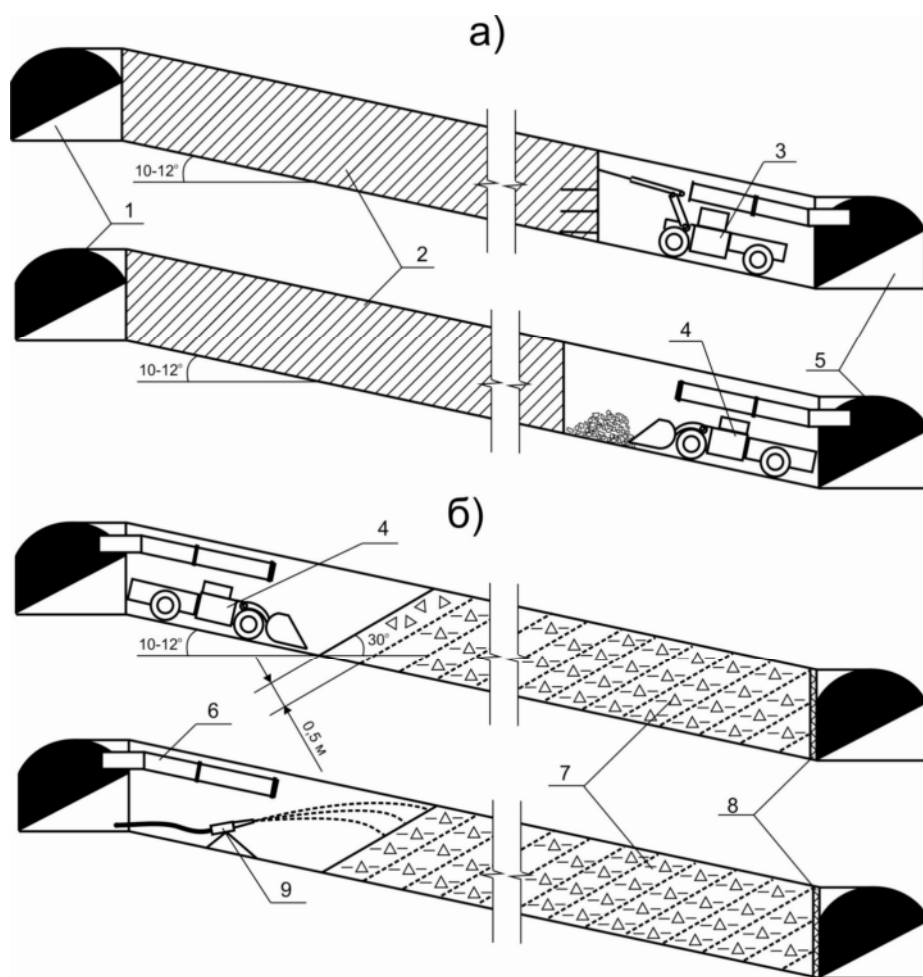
Принципиальная схема подземных горных работ с использованием льдопородной закладки и самоходного оборудования: а – отбойка руды; б – закладочные работы; 1 – вентиляционный штрек; 2 – камера; 3 – самоходная бурильная установка; 4 – погрузочно-доставочная машина; 5 – откаточный штрек; 6 – вентиляционный рукав; 7 – льдопородная закладка; 8 – перемычка; 9 – форсунка.
